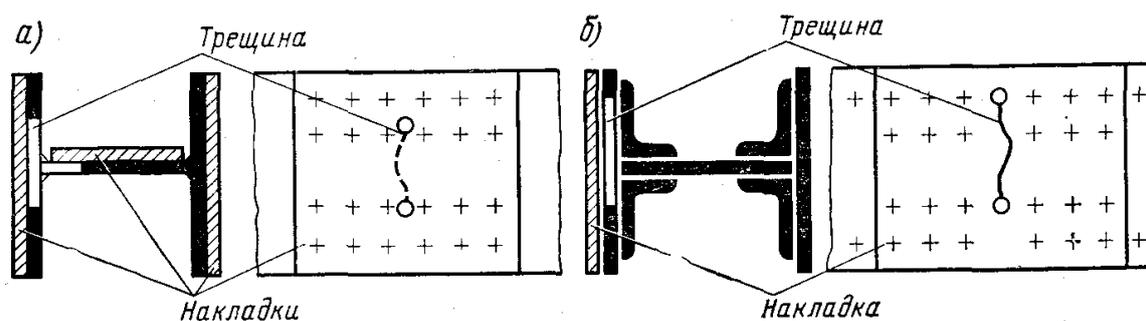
Перекрытие трещин накладками на высокопрочных болтах:
